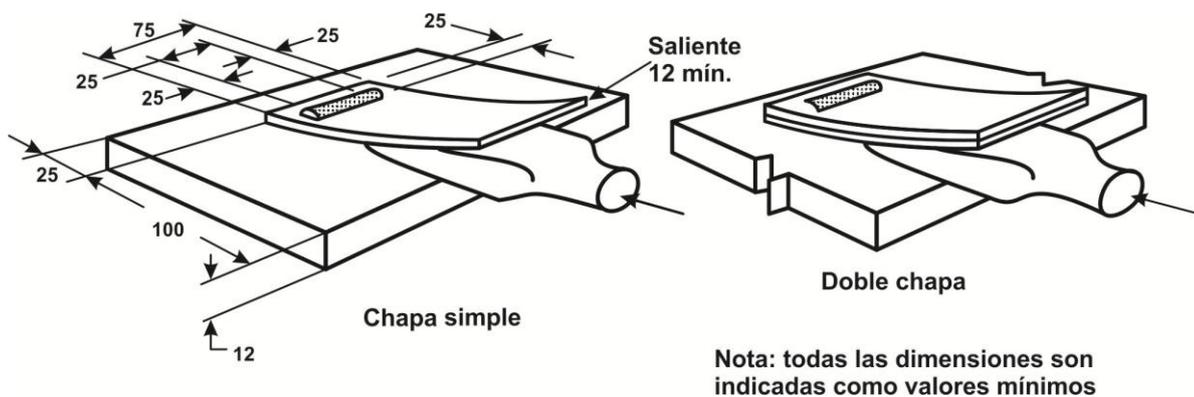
a). Esquema de ensayo para uniones entre chapa y elemento estructural portante con soldadura de costura por arco.
